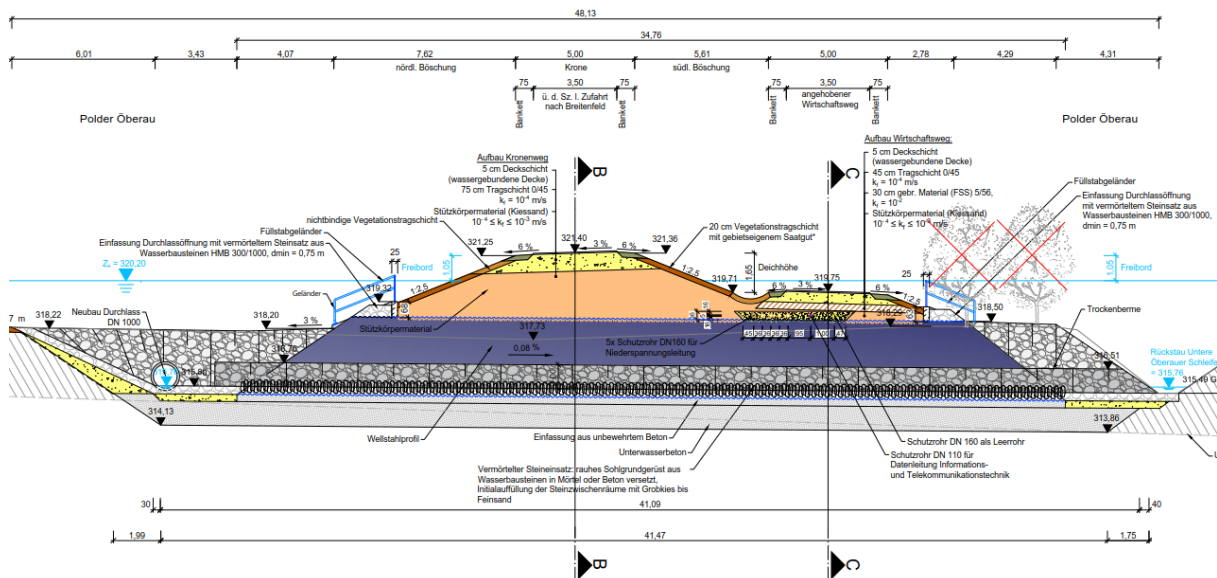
Ökologisches Durchlassbauwerk Oberau Nord, Schnitt A-A (aus Plan 04-11-05, Blatt 1/7)
